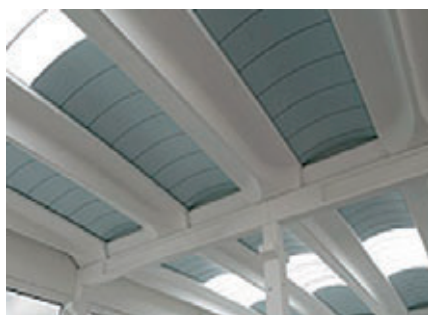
+ 2: Manufatti in calcestruzzo di Stai Prefabbricati
